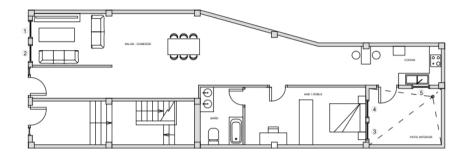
Plano Iluminación y ventilación. Fuente: Propia.
